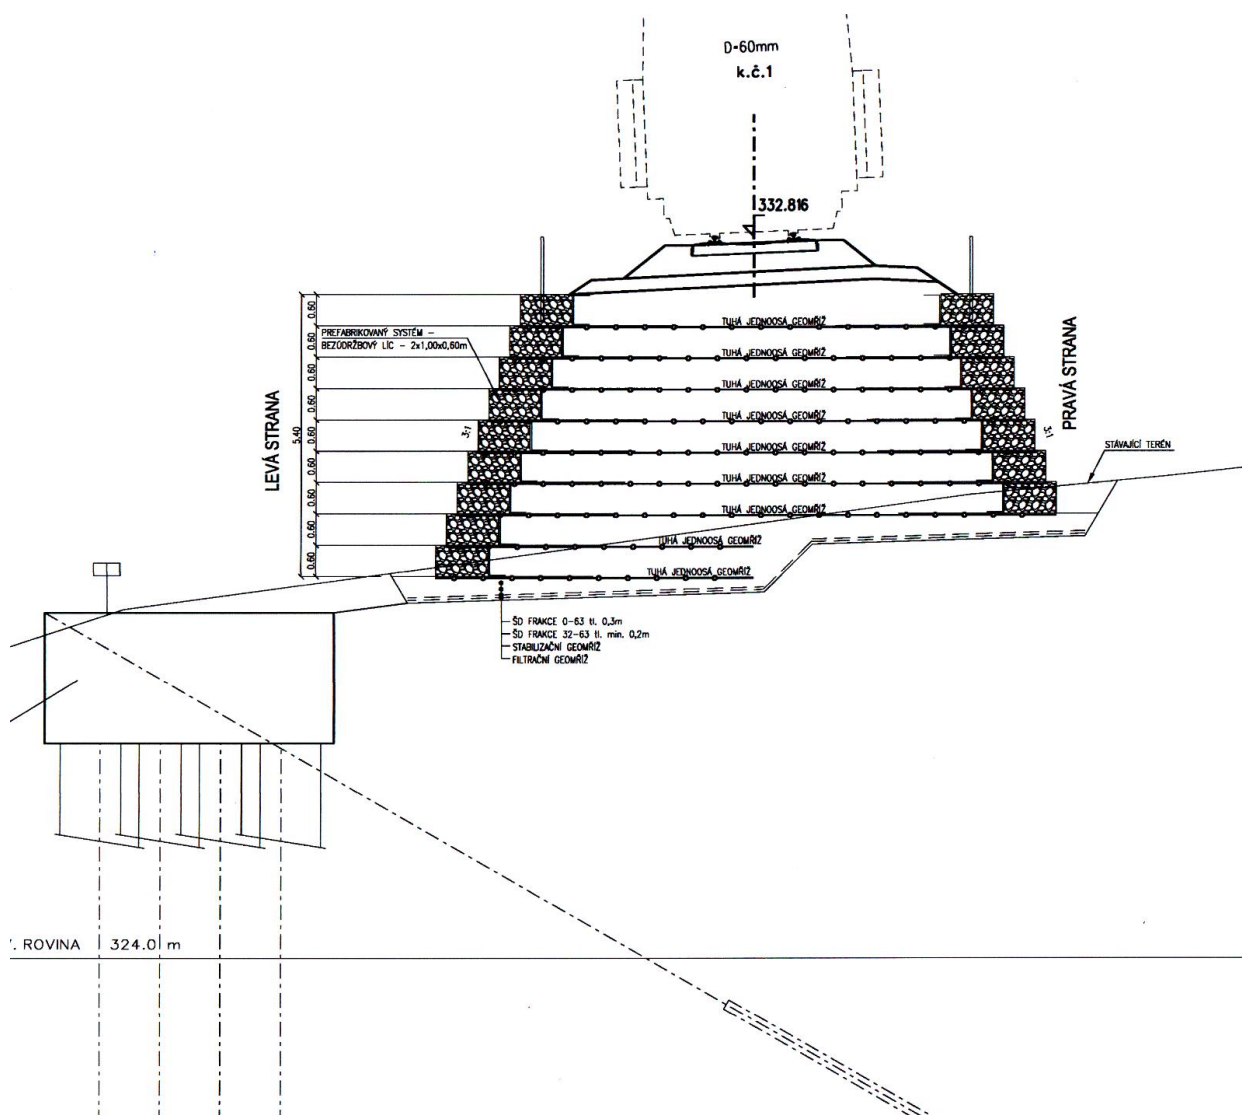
Detail geometrie statického stabilizačního prvku použité ve výpočtech.
